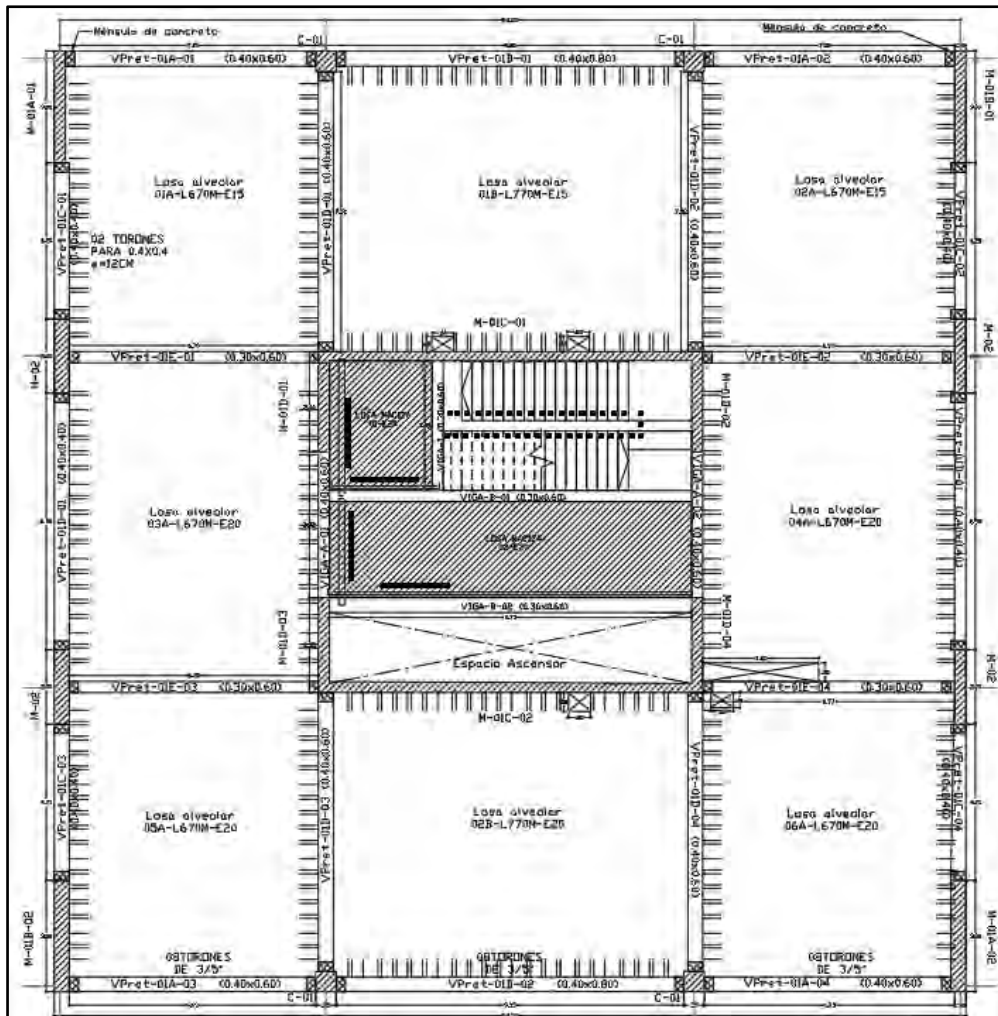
Estructuración del proyecto plano de planta típica (Fuente propia)
